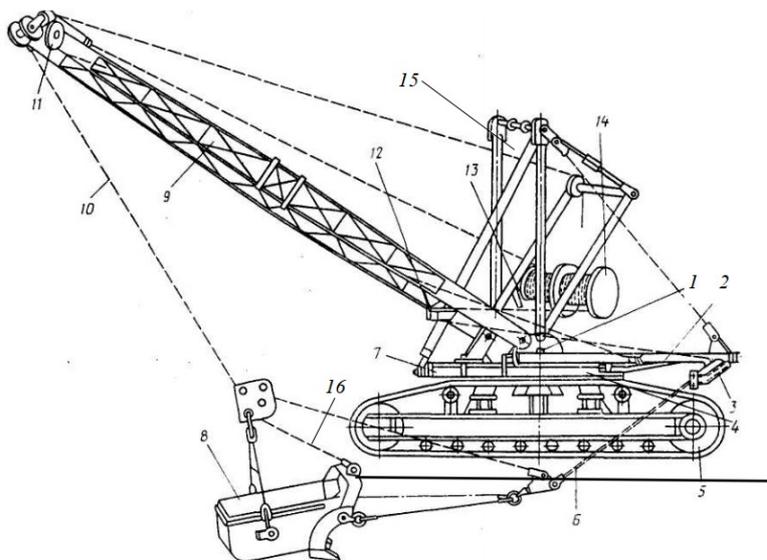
Оборудование драглайна бокового копания: 1 — вал; 2 — боковая стрела; 3, 12 — блоки; 4 — поворотная платформа; 5 — ходовая часть; 6 — тяговый канат; 7 — стопорное устройство; 8 — ковш; 9 — основная стрела; 10 — подъемный канат; 11 — головной блок; 13, 14 — барабаны главной лебедки; 15 — двуногая стойка; 16 — разгрузочный канат
